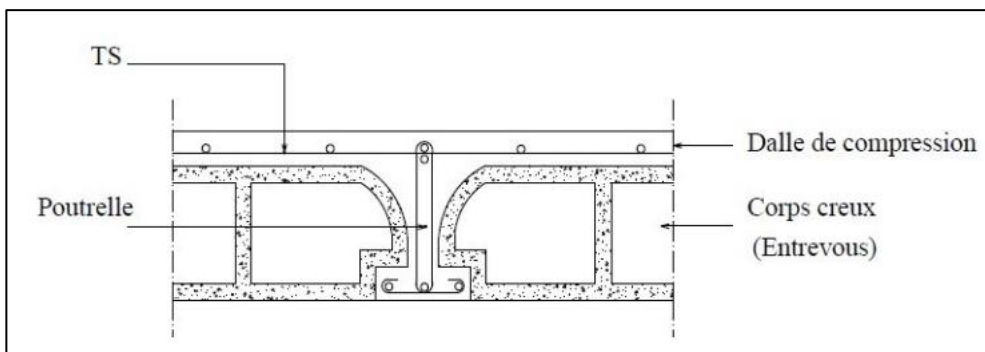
Coupe transversale d'un plancher à corps creux.
